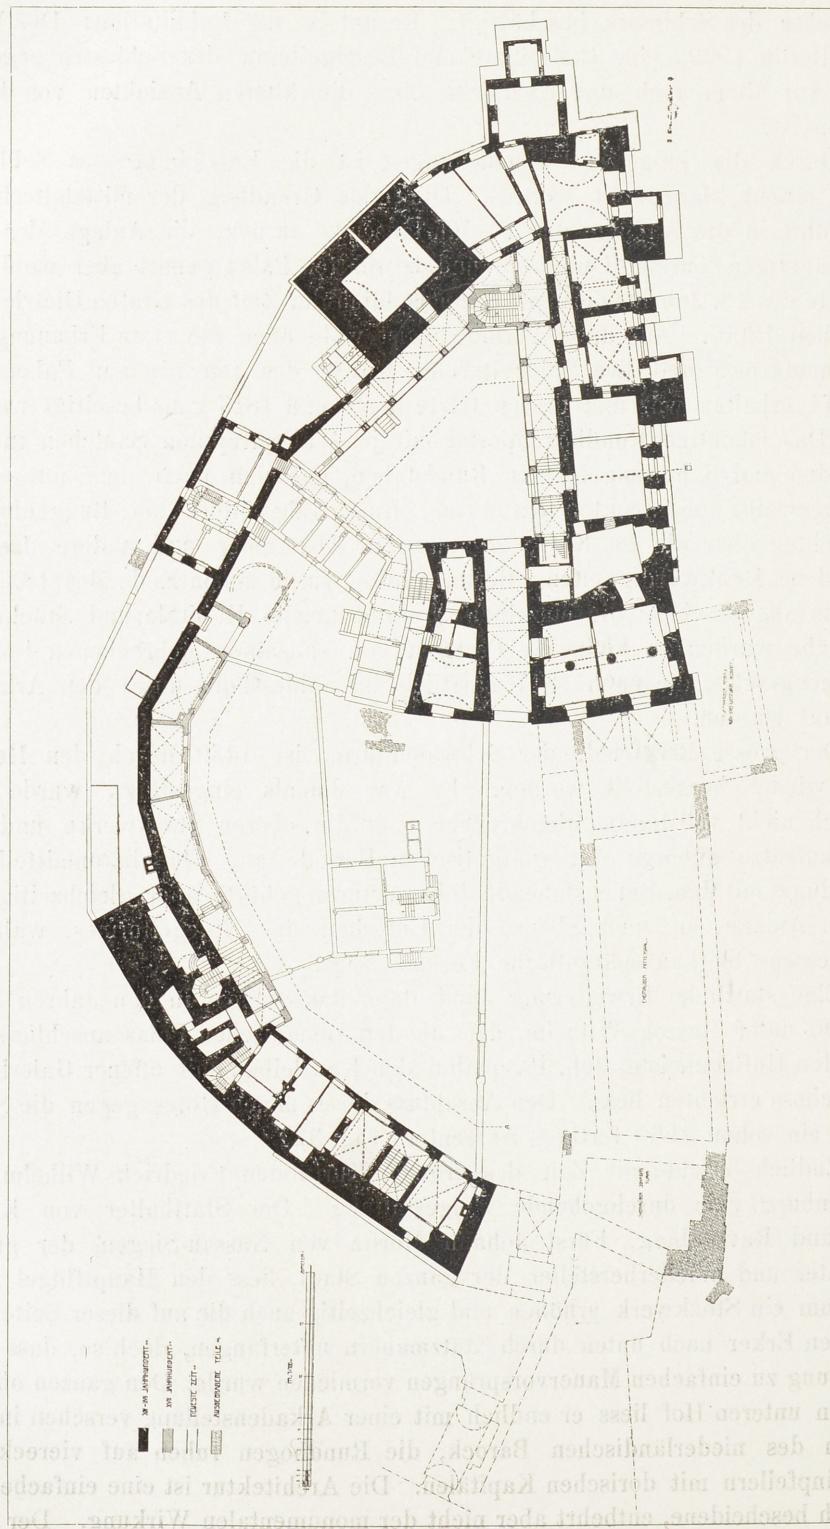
Cleve, Schloss. Grundriss des Erdgeschosses mit den Ausgrabungen. (Aufn. von J. Müller, 1909.)
